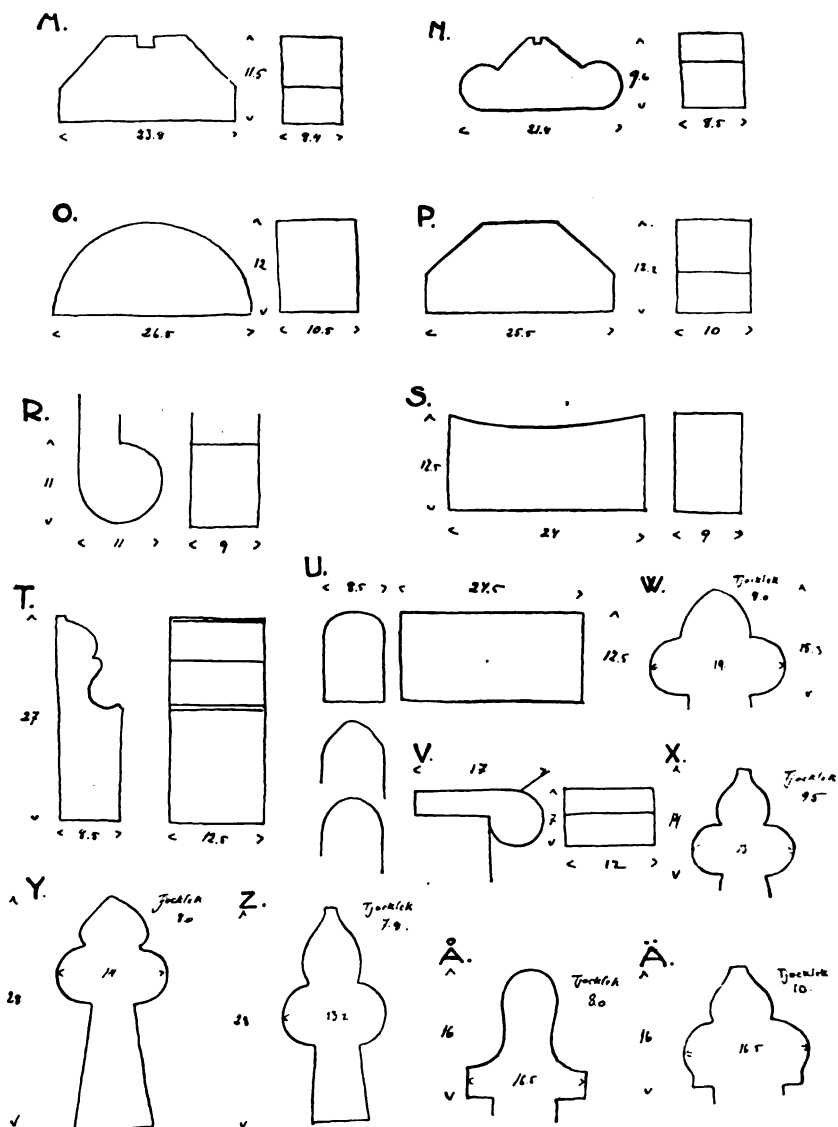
Formtegel skurna ur obrända tegelstenar.
